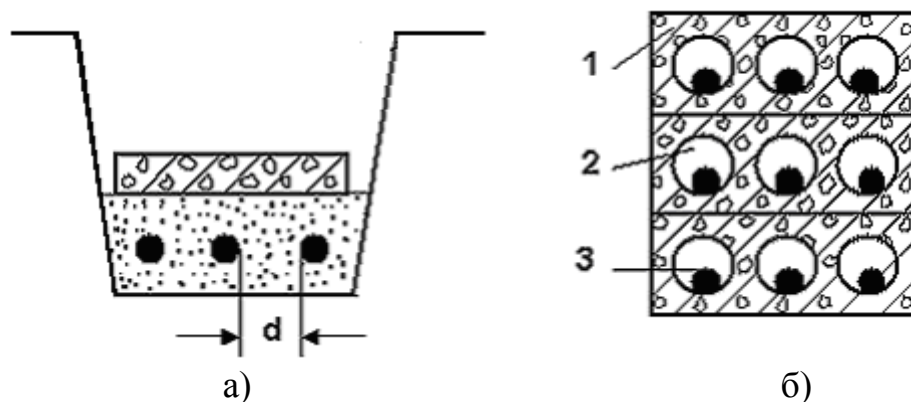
Прокладка кабелей в земляной траншее (а) и бетонном блоке (б)
